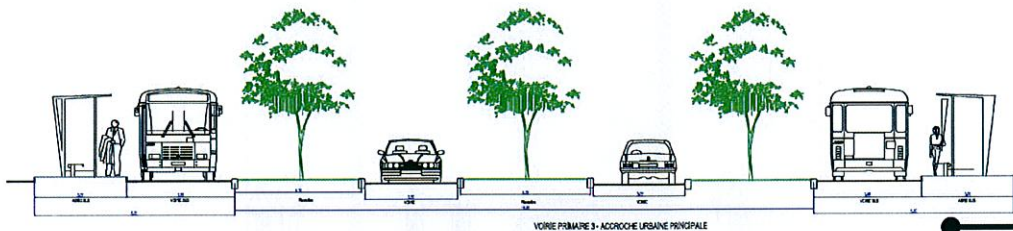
Profil en travers type Aménagement du carrefour central/Route de la corniche
